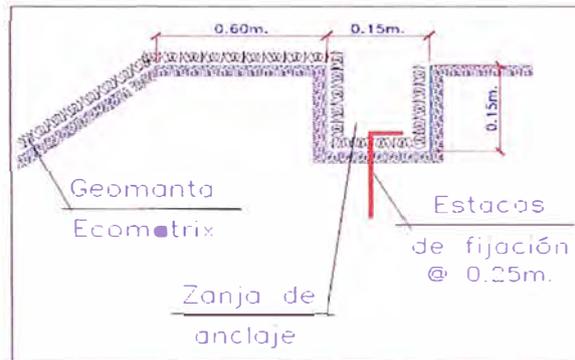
Detalle de zanja de anclaje y geomanta Ecomatrix.
